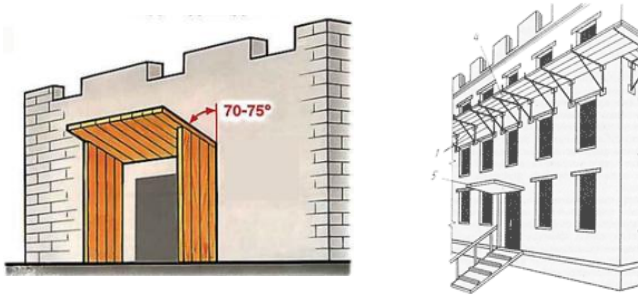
Захисний козирок над входом до будівлі (споруди)
